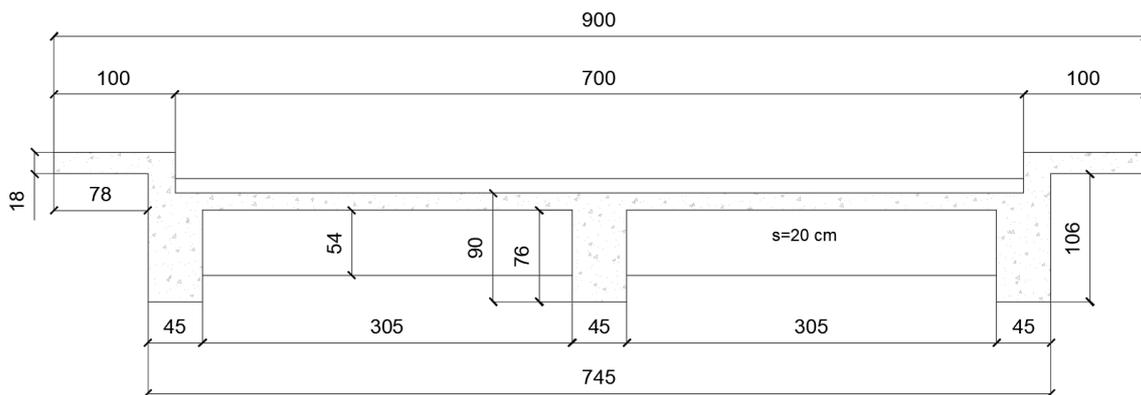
Sezione trasversale dell'impalcato del ponte (quote in cm)
